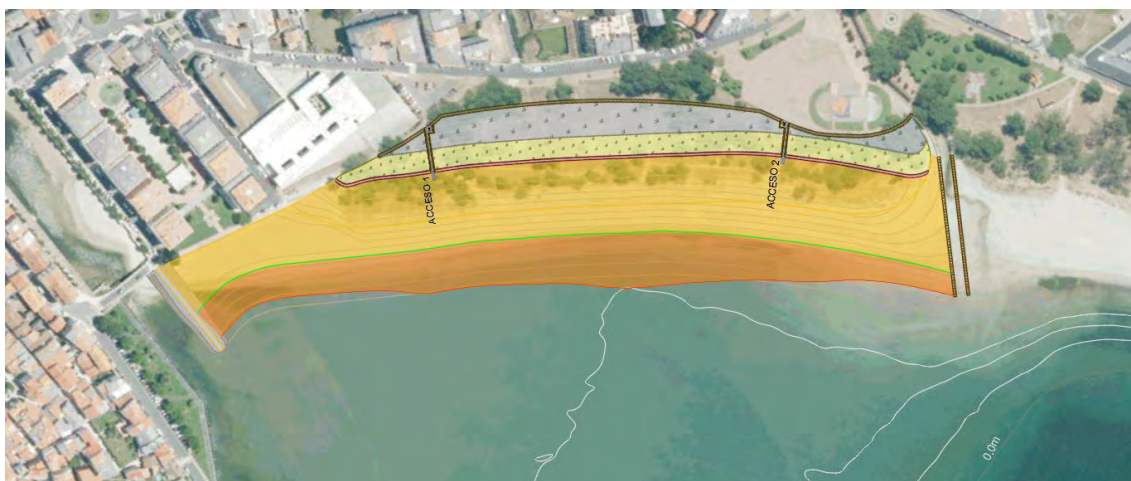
Planta de actuaciones. Fuente: Elaboración propia.
